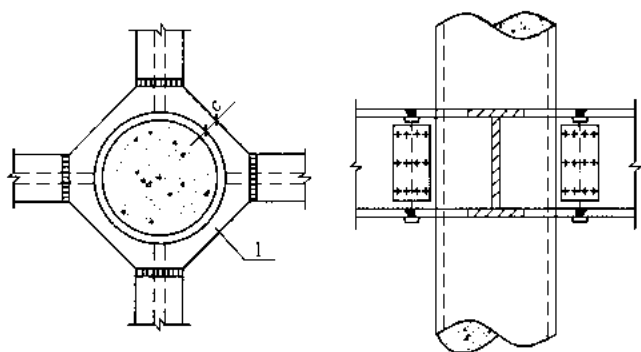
钢梁与钢管混凝土柱采用外加强环连接构造示意图
